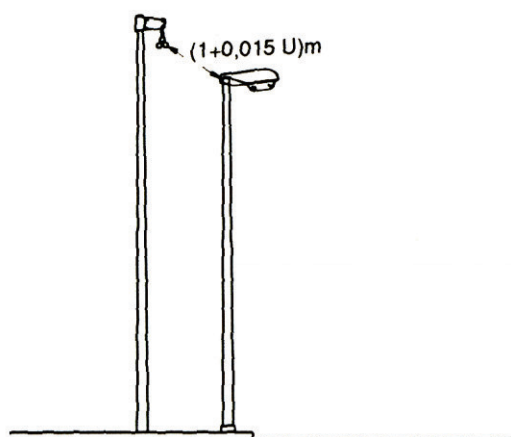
Distanza di rispetto dei centri luminosi dalle linee in cavo.
